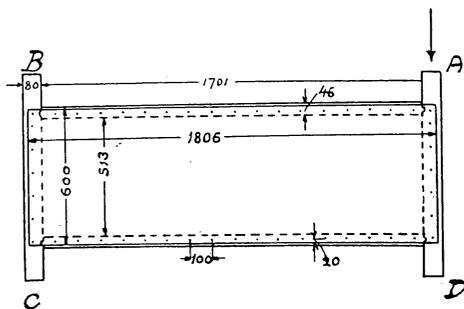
Wandfach zur Prüfung der Schubfestigkeit einer Blechplattenhütte. Die Dimensionen sind in Millimetern angegeben.
